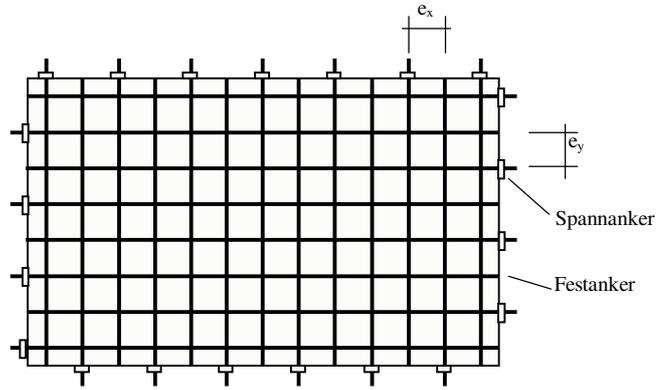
Grundriss einer kreuzweise vorgespannten Betonfläche
